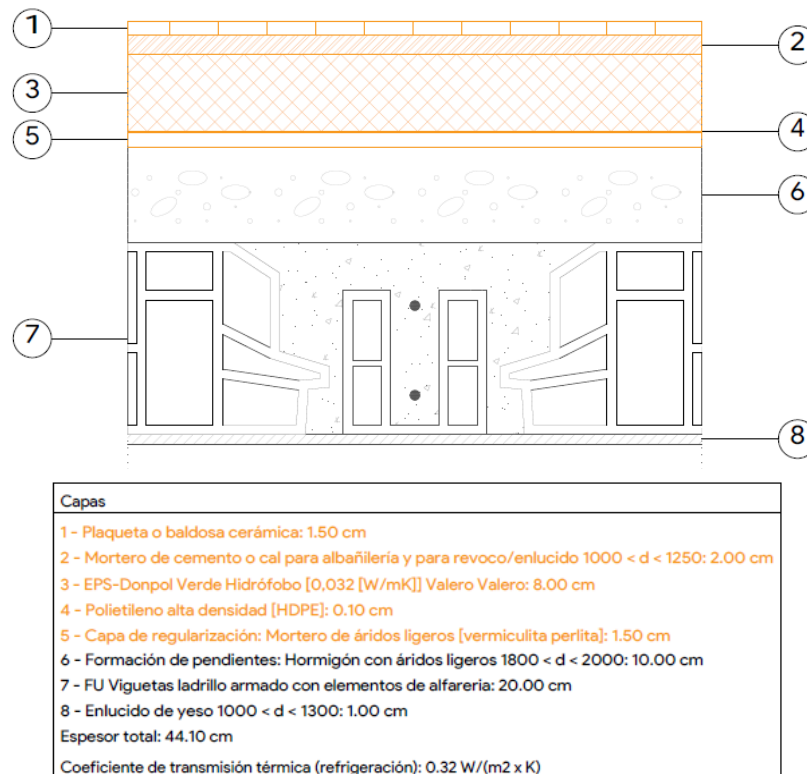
Detalle de cubierta mejorada (Elaboración propia)
